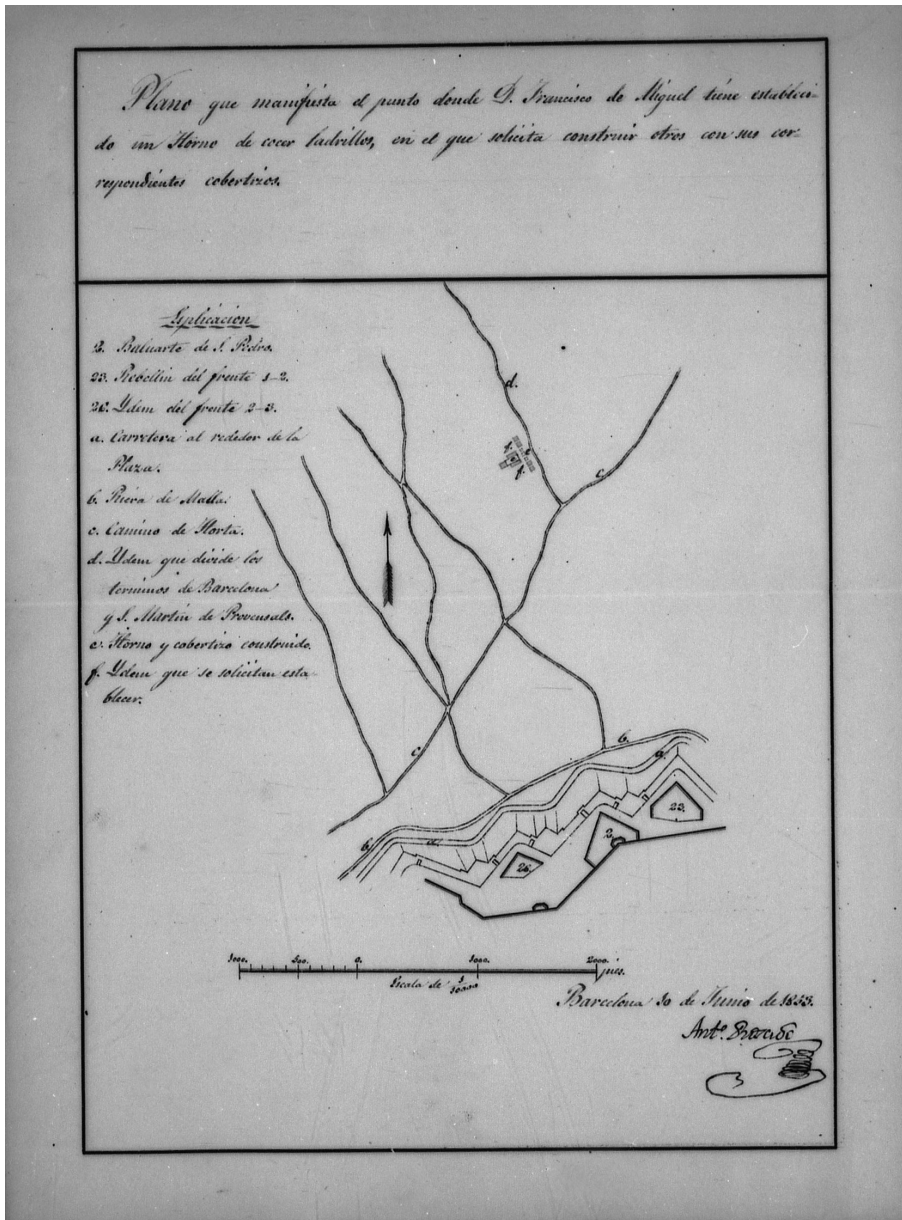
Plano de situación de La Hispana de 10 de junio de 1853, realizado por los ingenieros militares, en el que se indica la planta de lo ya edificado y de lo que se quiere añadir (ACA, Comandancia de Ingenieros, caja 29).
